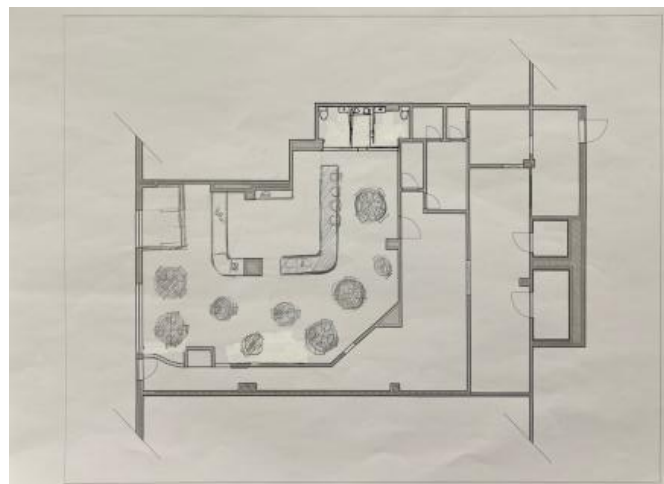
Planta de estudo 3. Fonte: Autora, 2025
